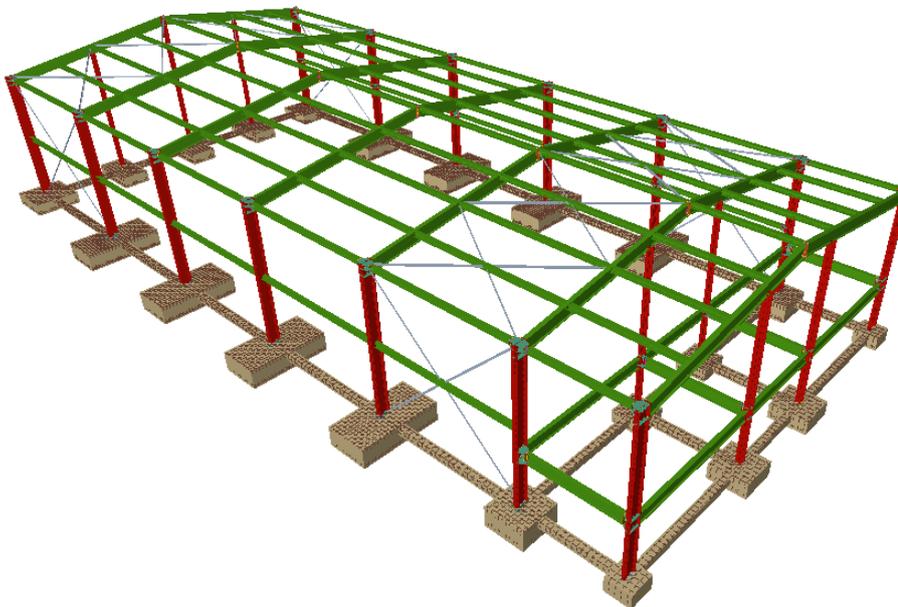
Solución final de la estructura. Fuente: CYPE 2017
